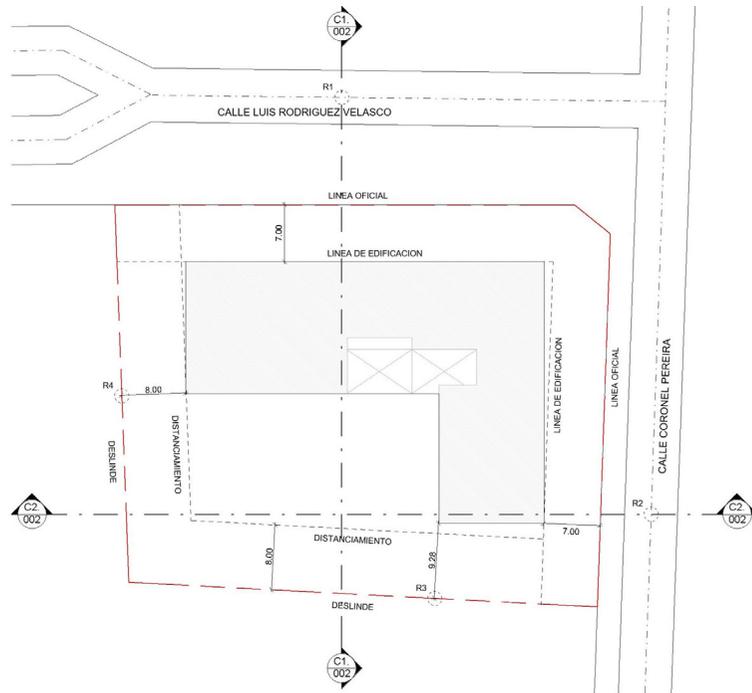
Planta Emplazamiento Cabida Uso Mixto.
